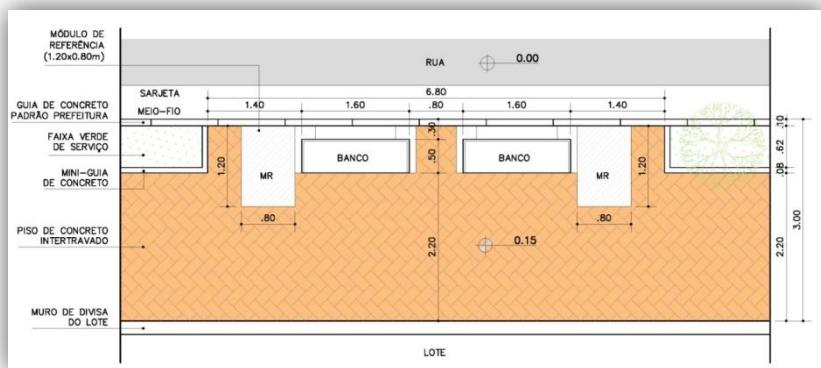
Planta do detalhe tipo 16 A1: Bancos públicos (calçada largura de 3,00m); sem escala.
